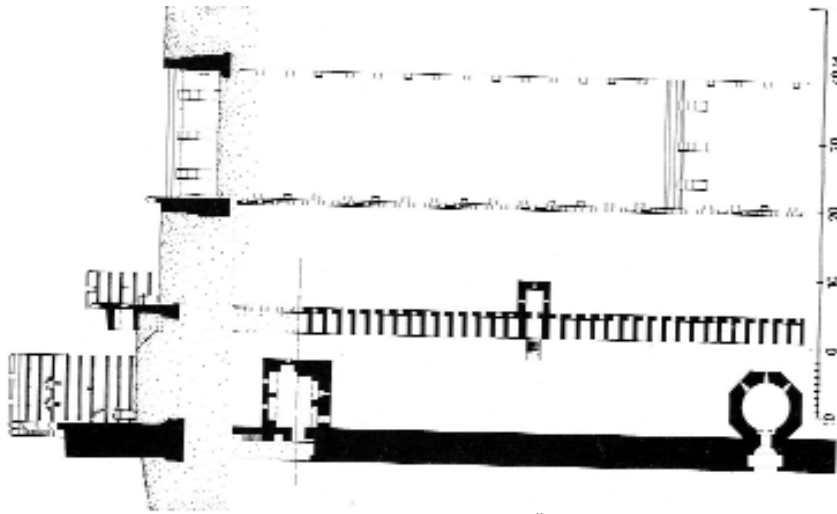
Planimetria e sezione del sistema fortificatorio teodosiano (MÜLLER WIENER 1977).
